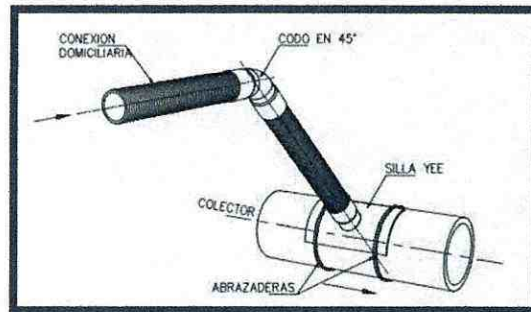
Detalle isométrico de acometidas en pavimento rígido
